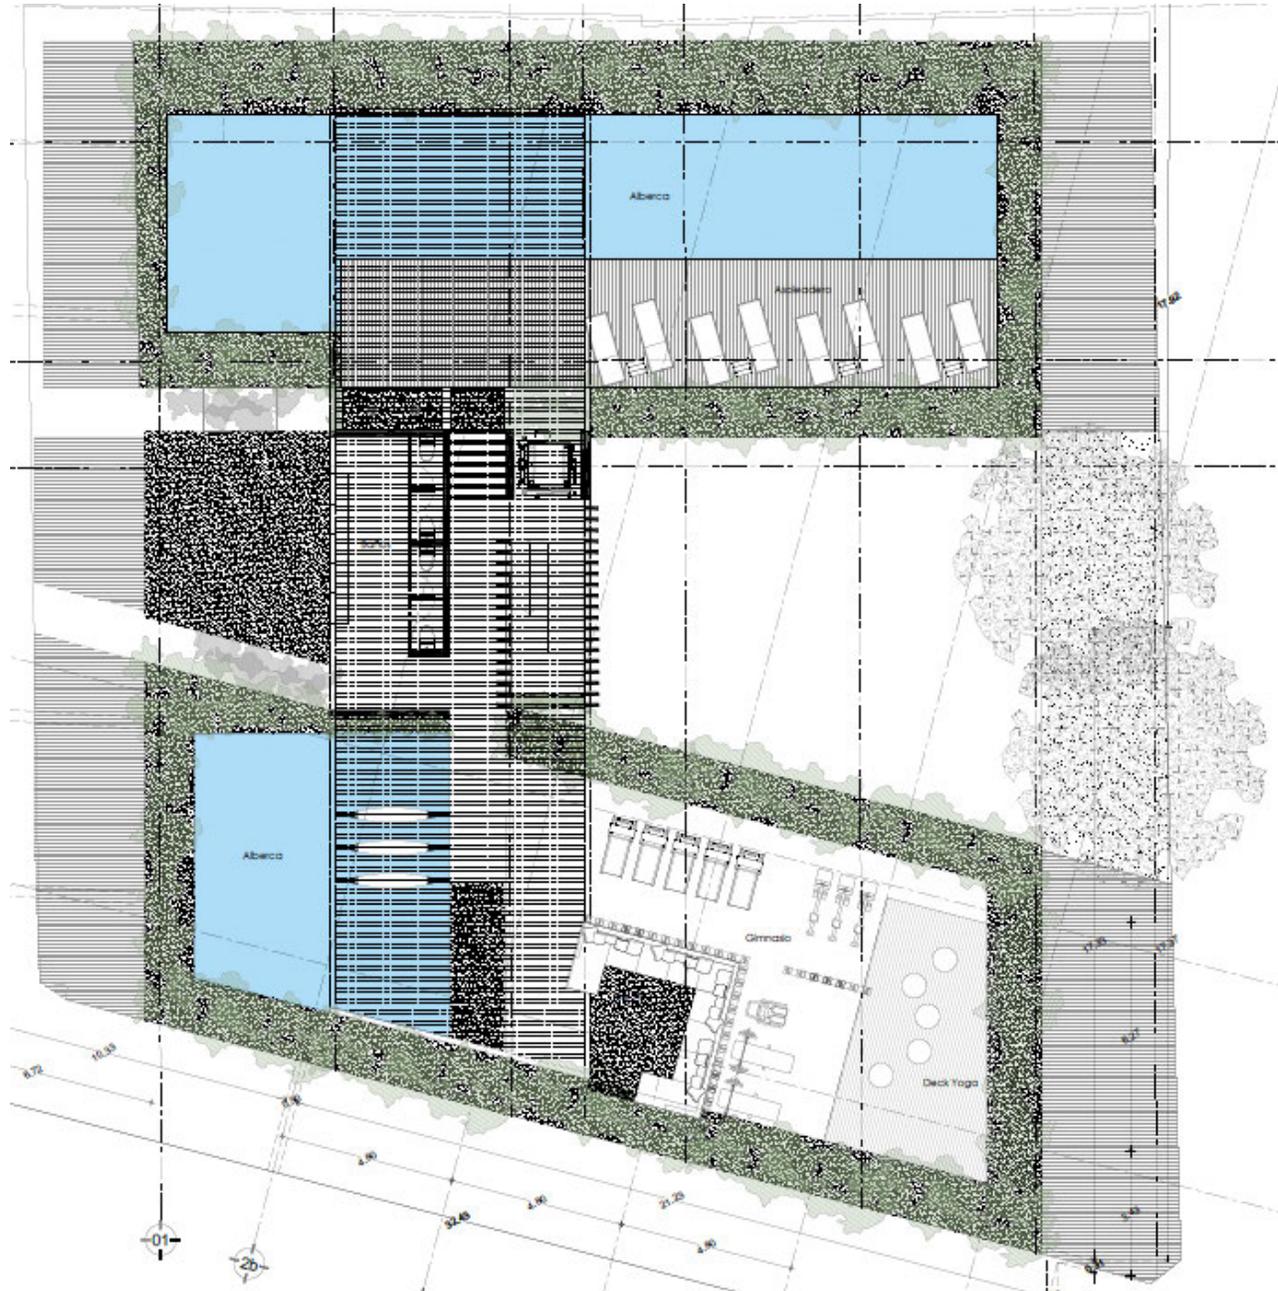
Planta arquitectónica Roof Garden, Fuente: Plano Arquitectónico.
